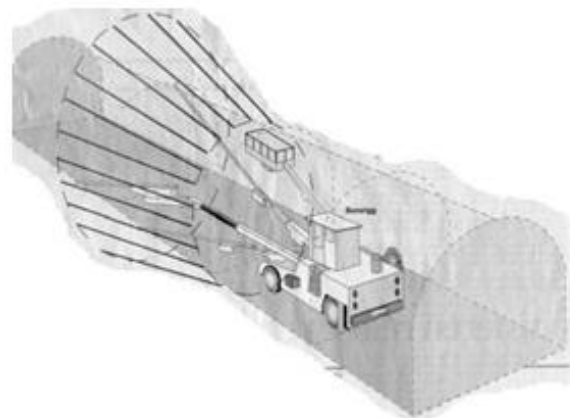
Ilustração esquemática da execução de enfilagens tubulares longitudinais (Keller Tecnogeo, 2020).
